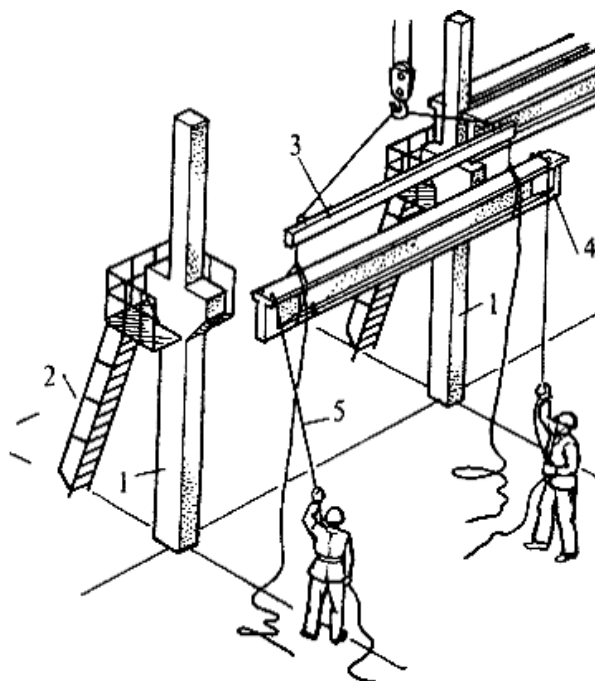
Схема установки подкрановой балки: 1 – колонна; 2- приставная лестница; 3- траверса; 4 – подкрановая балка; 5 – пеньковая оттяжка
